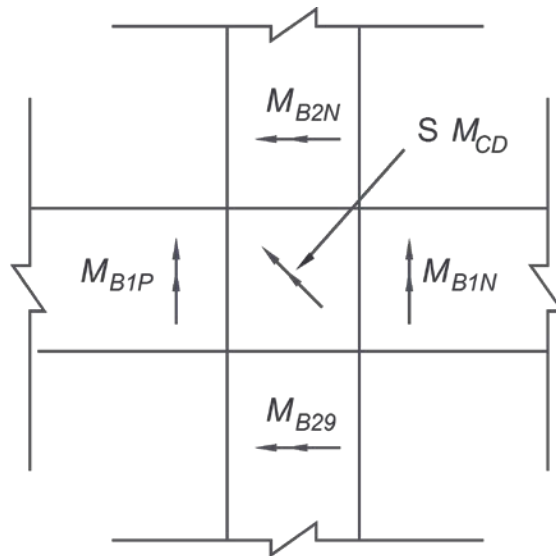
11 Planta de nudo de columna interior sometido a momento bidireccional (Priestley et al. 2007)
